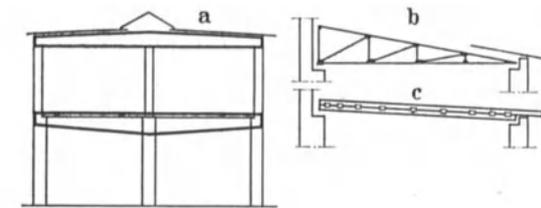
Nach a I-Balken für Nutzdecke und Dach. Nach b verdübelter Balken statt Fachwerkgliederung.
